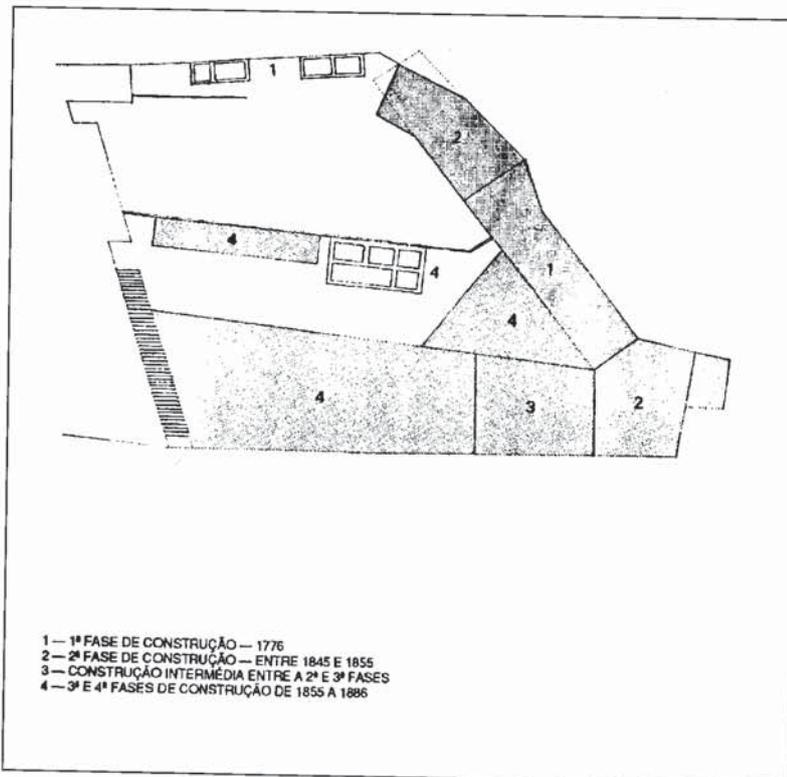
Fábrica de Massarelos, fases de construção das instalações na rua da Restauração (Esc. apr. 1:850).
